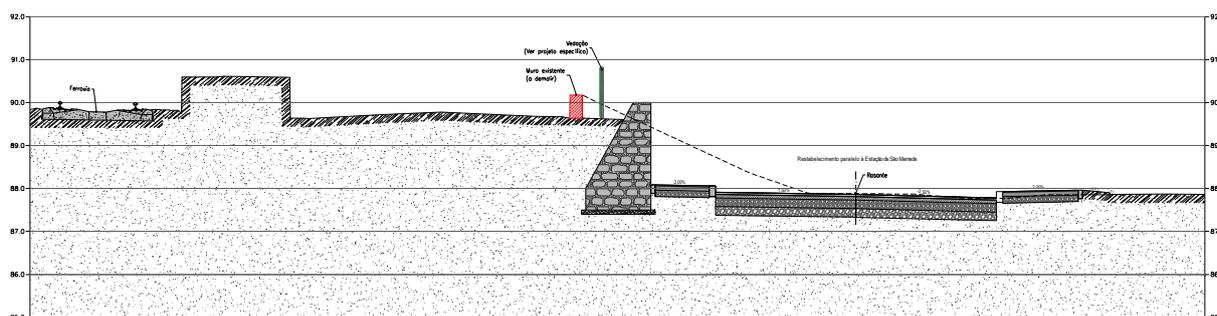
Perfil transversal ao KM 0+006,00 – MSM1 (Secção 1)
